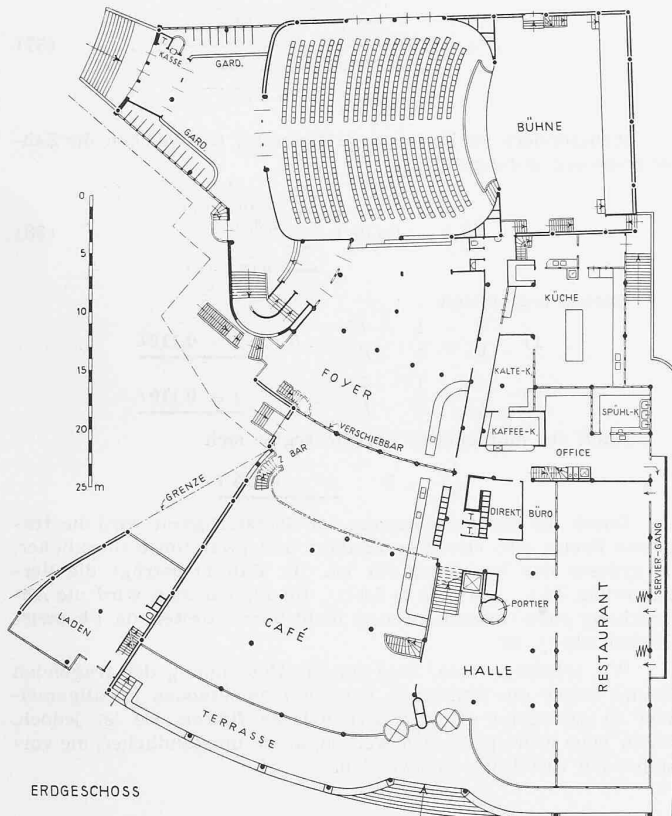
und 2. Grundrisse und Schnitt 1:600 des Grand Hotel Gooi in Hilversum. — Arch. † J. DUIKER.
